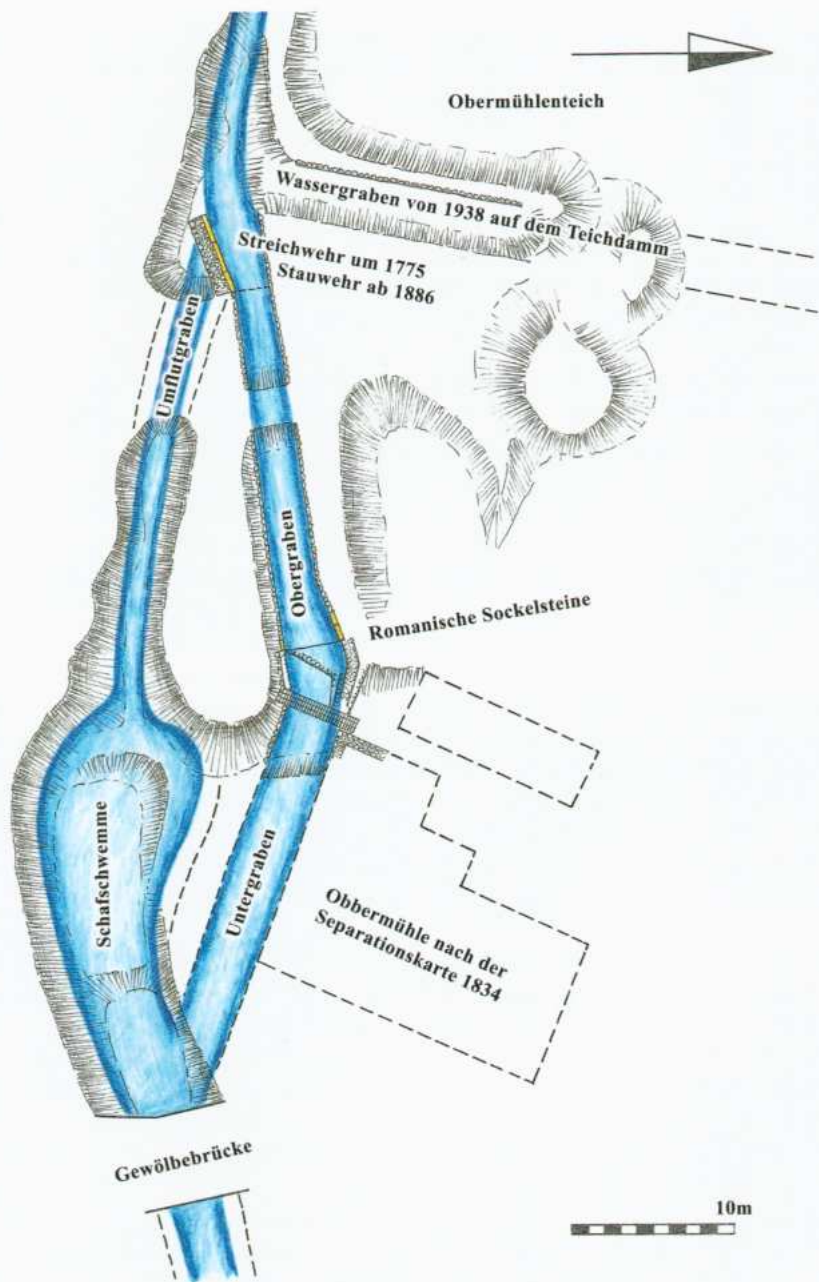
Lageplan der Obermühle mit deren wasserbautechnischen Anlagen.
